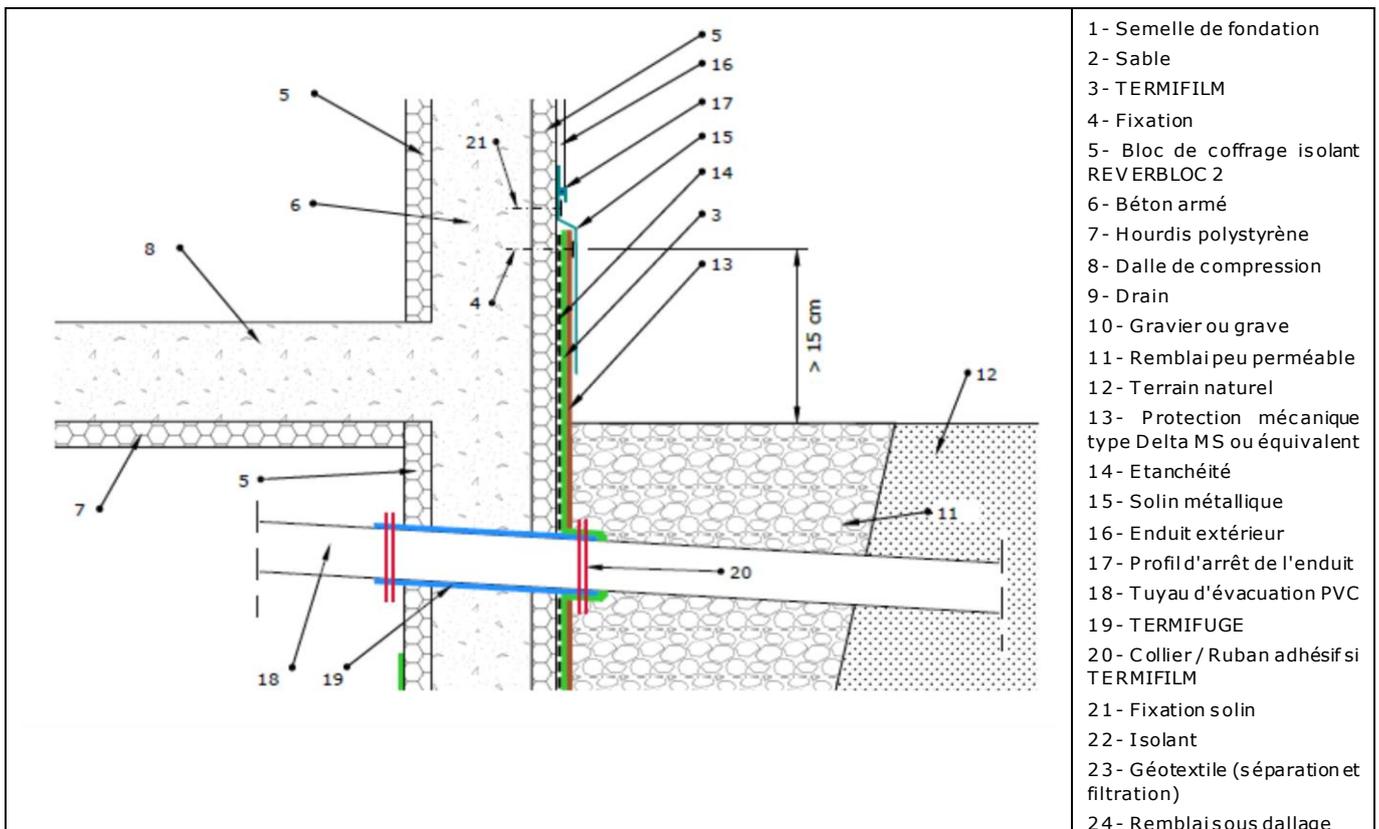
Traitement des traversées horizontales sur mur extérieur enterré (1).
